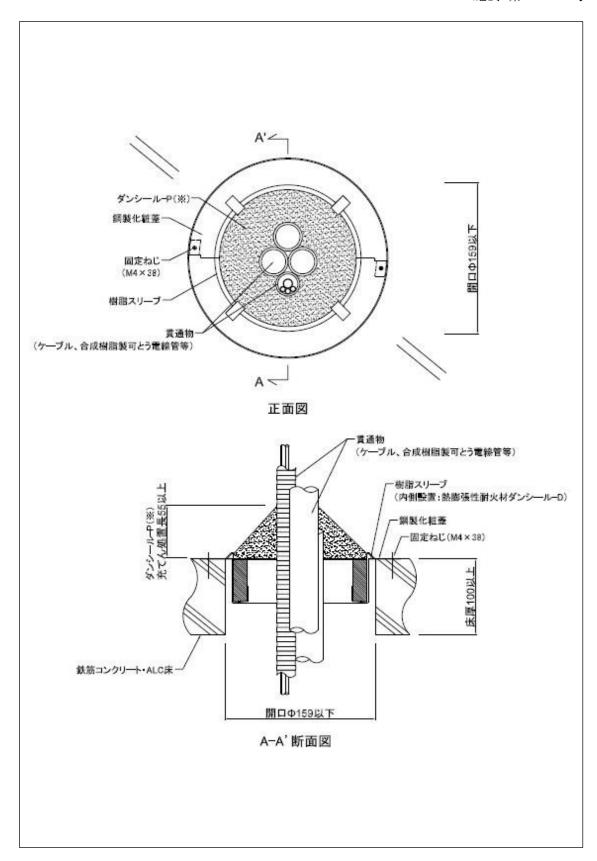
プチロクワイド消防キット 標準施工図(鉄筋コンクリート・ALC 床)
